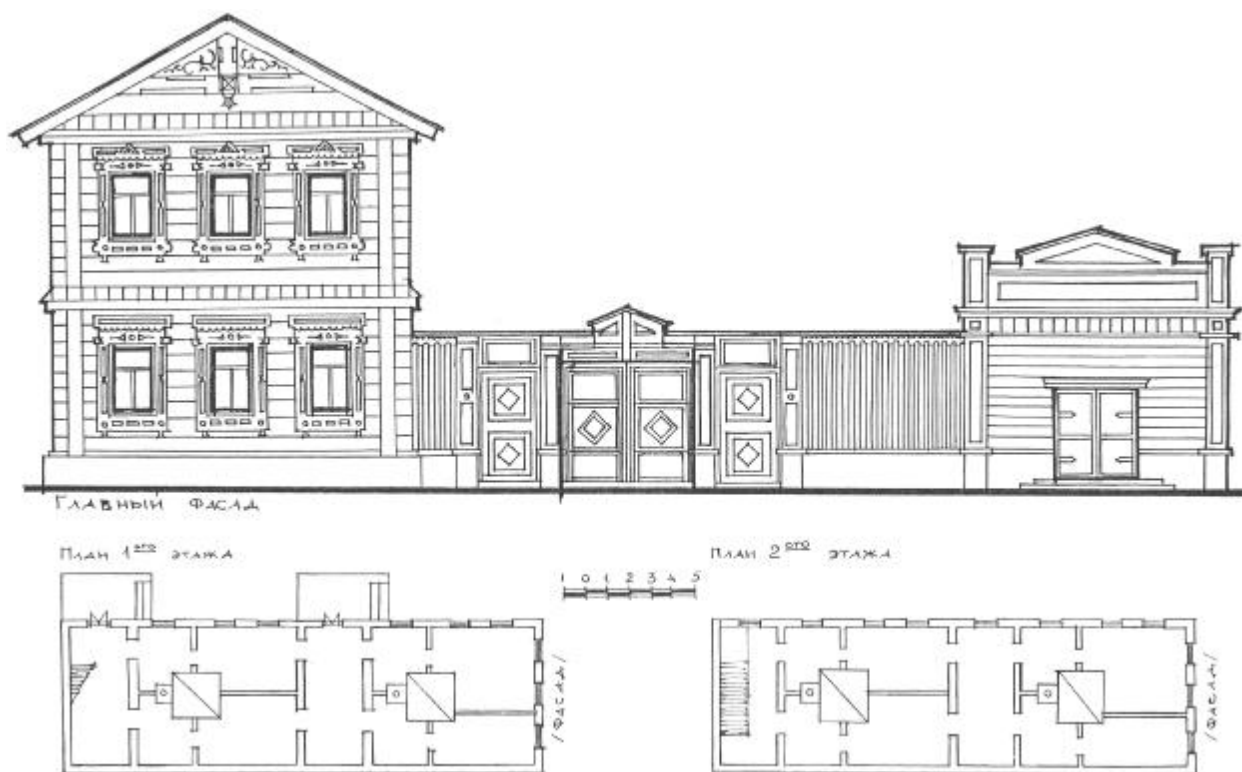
Фасад и планы дома Мухамеда Яушева. Проект 1902 года
